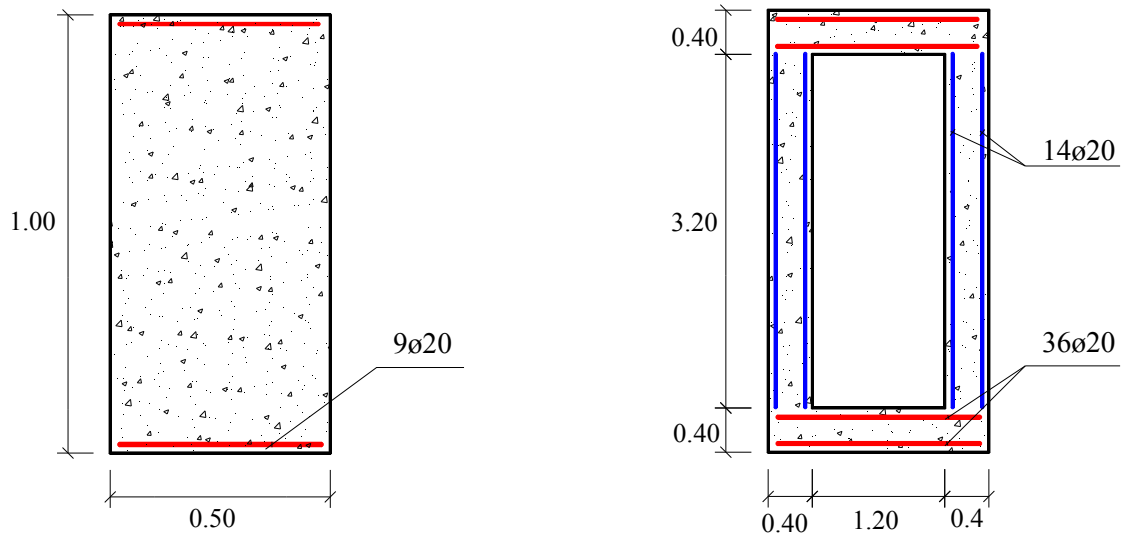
Esquema de pormenorização das secções transversais de betão armado para realização do estudo comparativo. Caso A de secção rectangular simples (*esquerda*) e o caso B da secção rectangular oca (*direita*)
